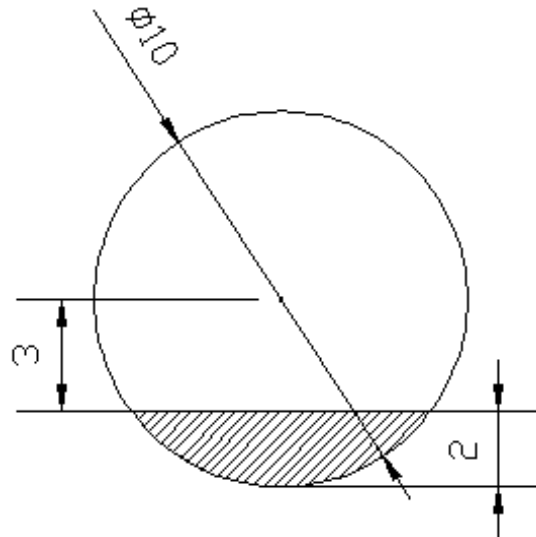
Vista transversal de la secci3n fisurada para la barra 11
